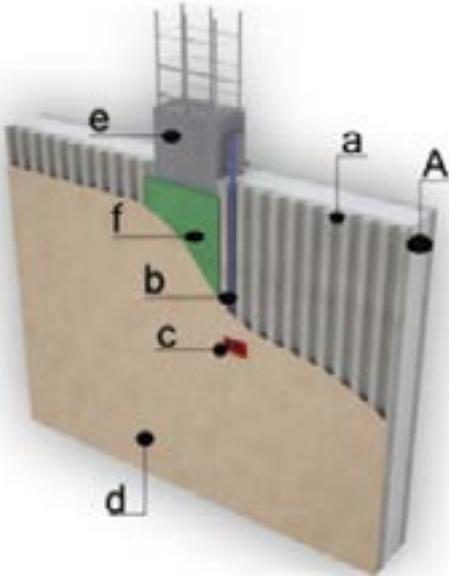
\_5. Il muro S32 modul5, in assonometria (Fonte: <https://www.sarotto.it>)
